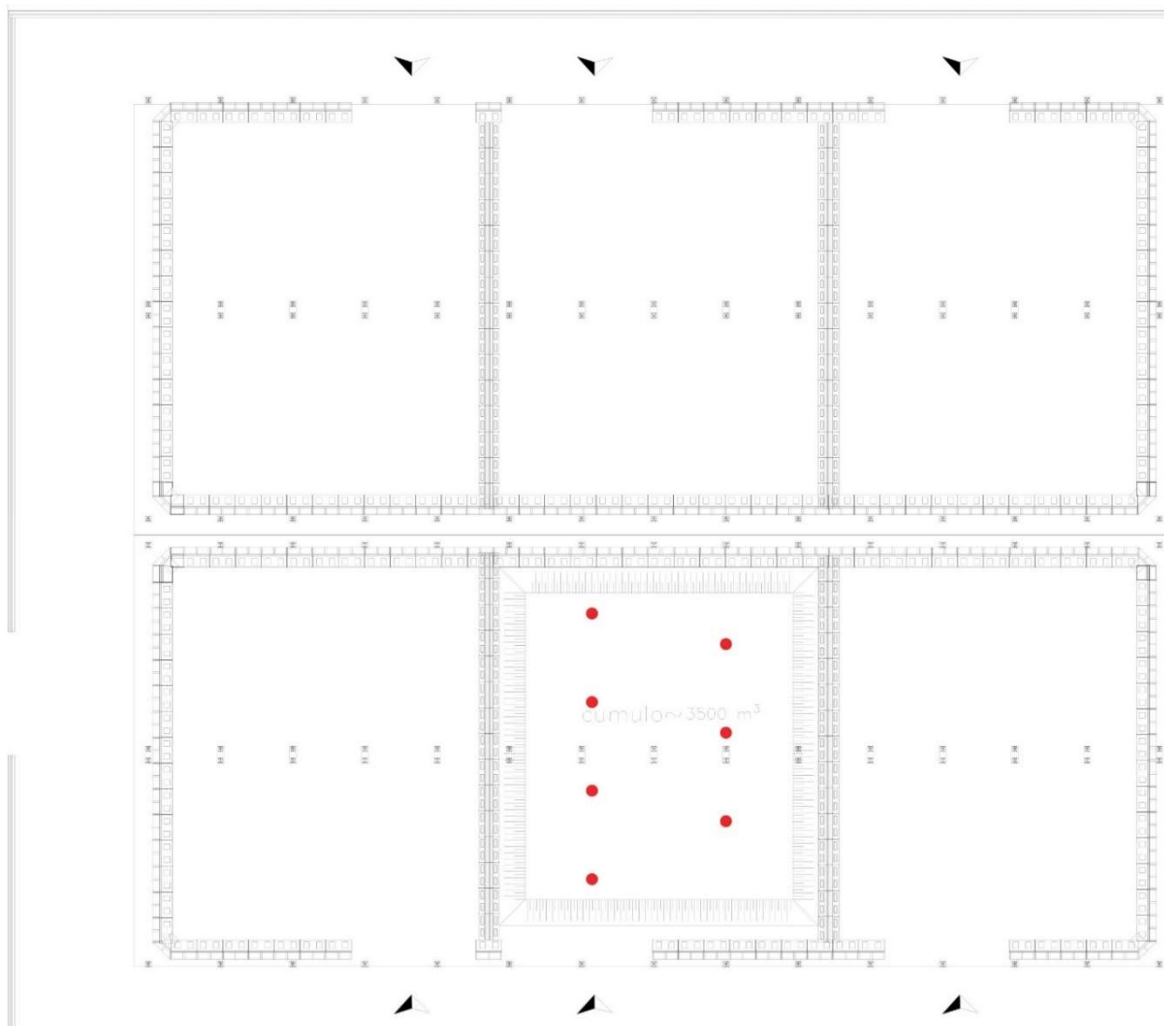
Schema planimetrico con individuazione dei prelievi (in rosso) nella baia
